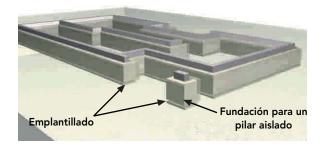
9 : Solución de fundación continua con emplantillado de 8 cm de hormigón pobre.
